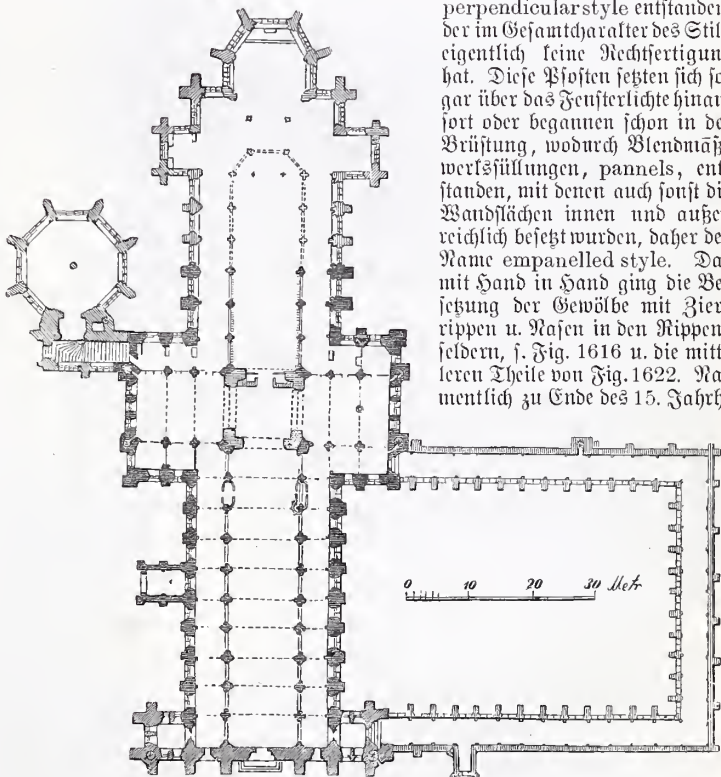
Grundriss der Kathedrale von Wells (decorated style).
